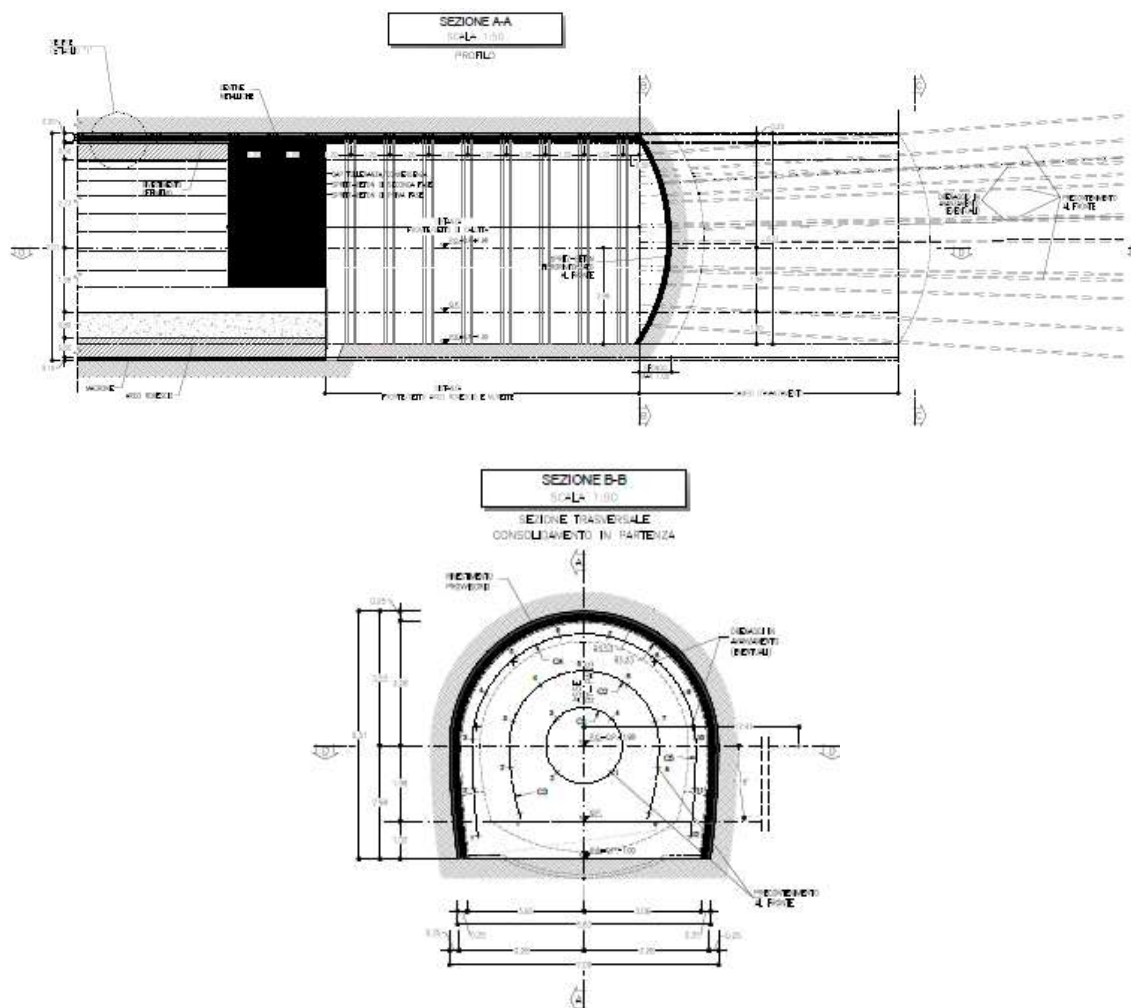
Sezione tipo B2 bypass area di sicurezza
